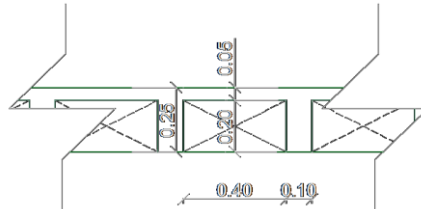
Esquema de la sección transversal de la losa de entrepiso.
